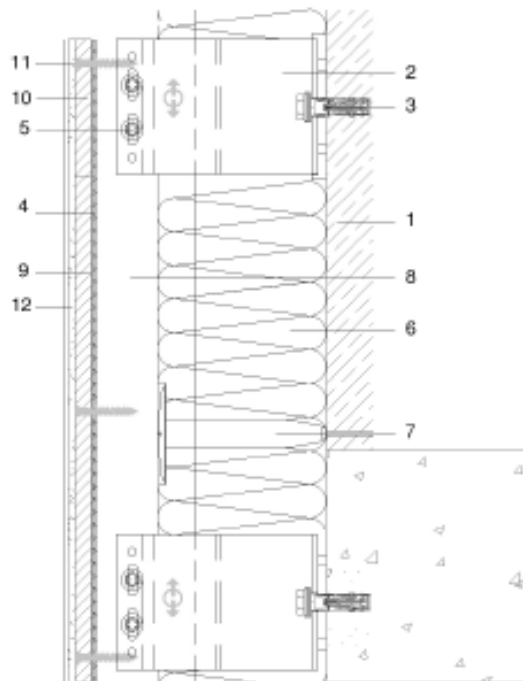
Detalhe construtivo de encontro com forjado [78].
